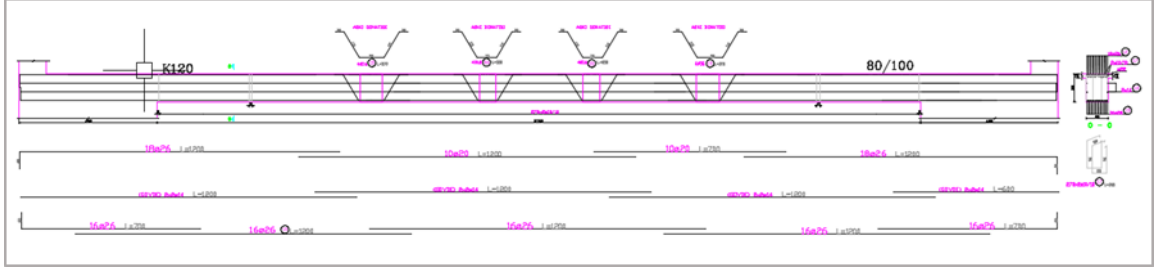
Panorama 1326 statik proje görünüm 5
